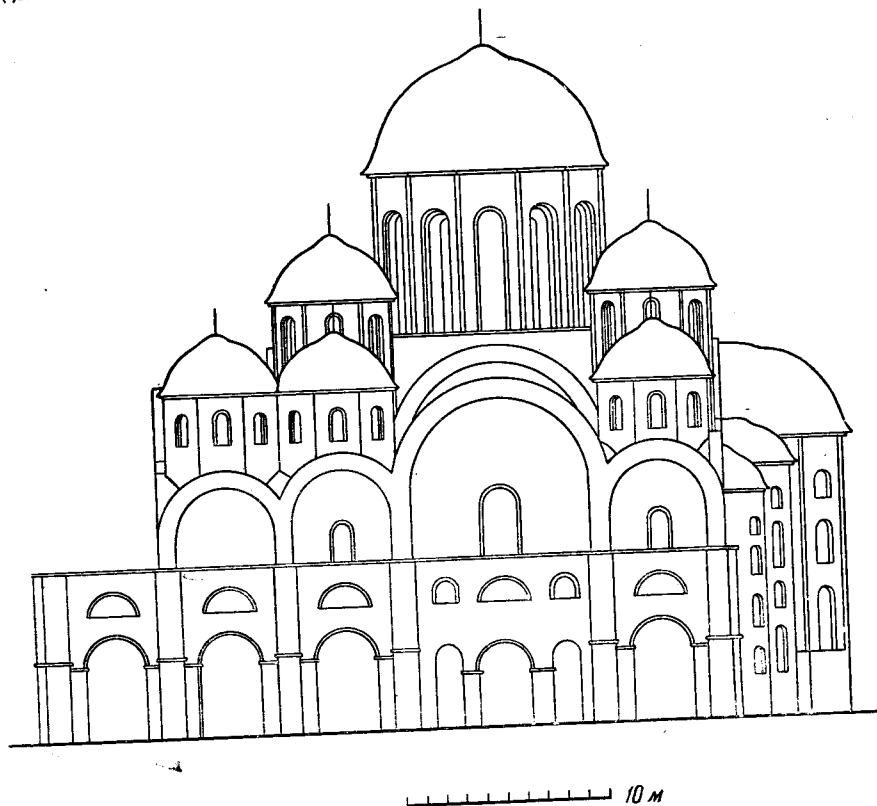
Схема реконструкции южного фасада Софии в Киеве
